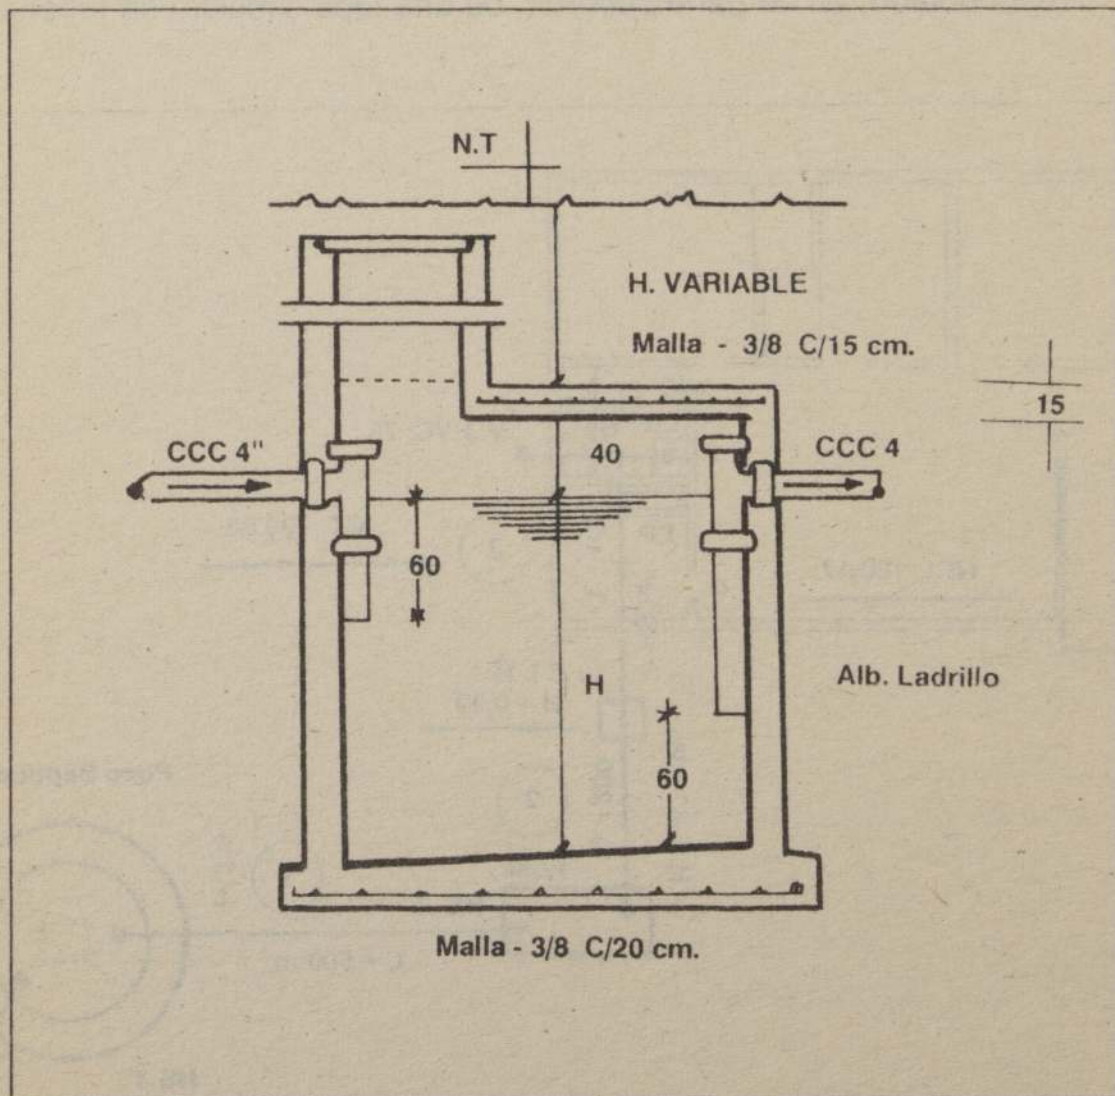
Detalle de fosa séptica, construída en albañería de ladrillo.
